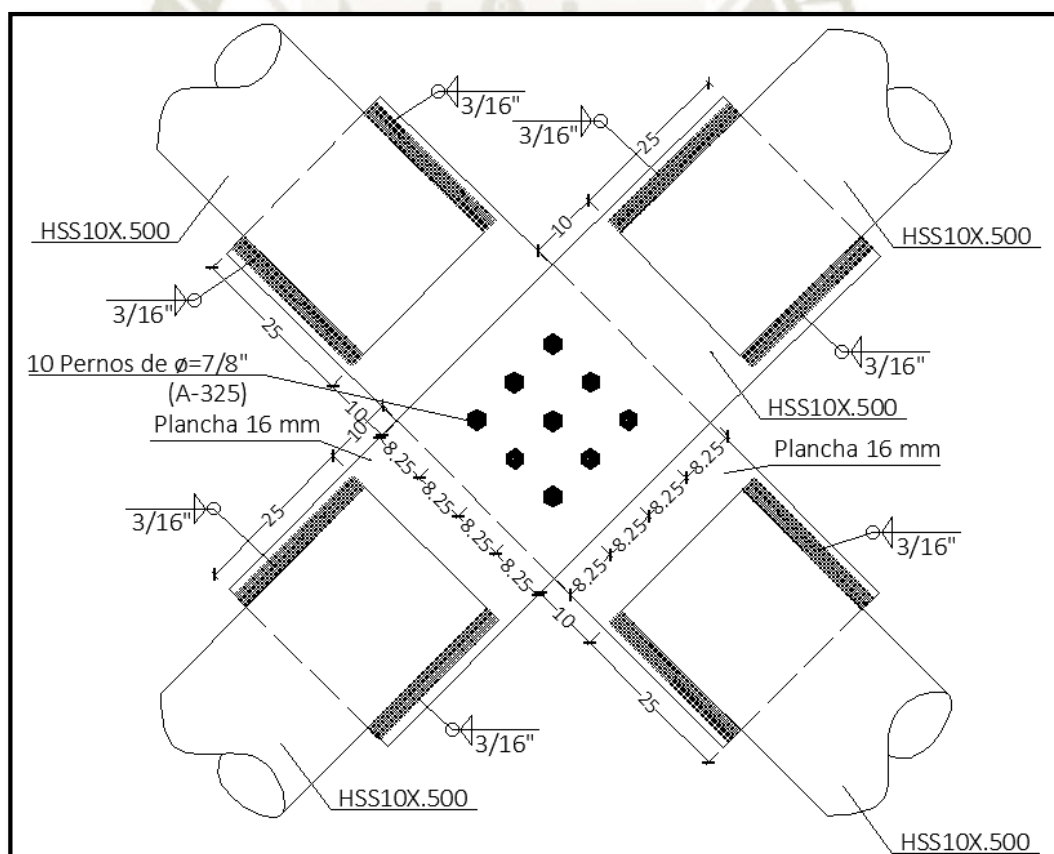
Detalle 2 Conexión de arriostres. (Fuente: Elaboración propia)
